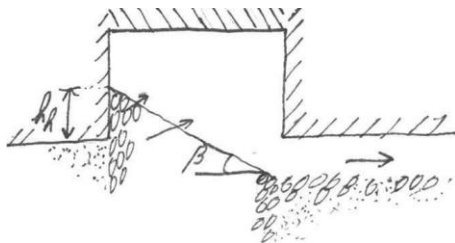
Uitspoeling van bovendeele barrière aansluitend op benedenstroomse pipe tot ongeveer een hellingshoek gelijk aan de hoek van inwendige wrijving. De geschetste situatie betreft een relatief brede barrière met een relatief lage inkassing (zijaanzicht met enige 3D-suggestie in langsrichting).
